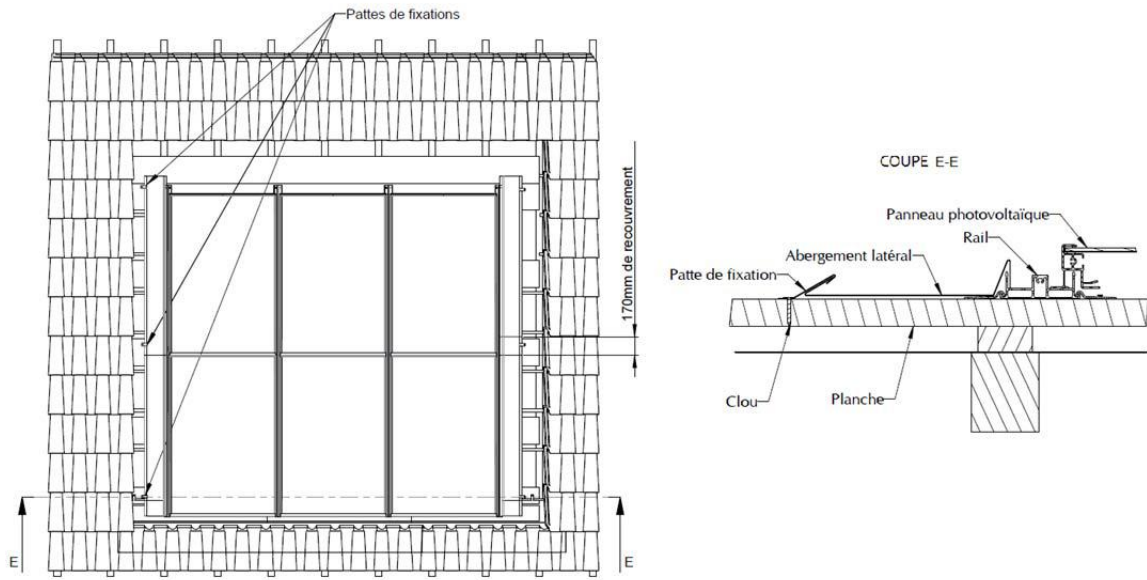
Pose des abergements latéraux droit et gauche pour installation sur toiture tuile
